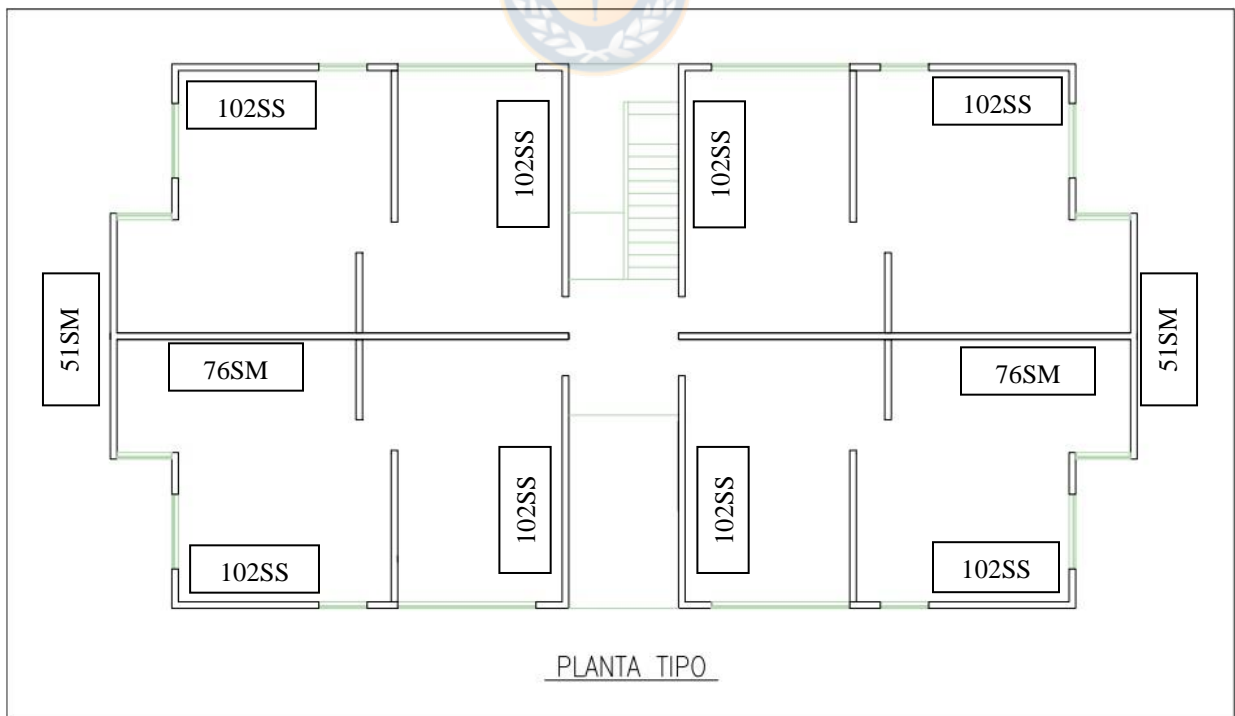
Vista en planta del segundo piso modelo completo
